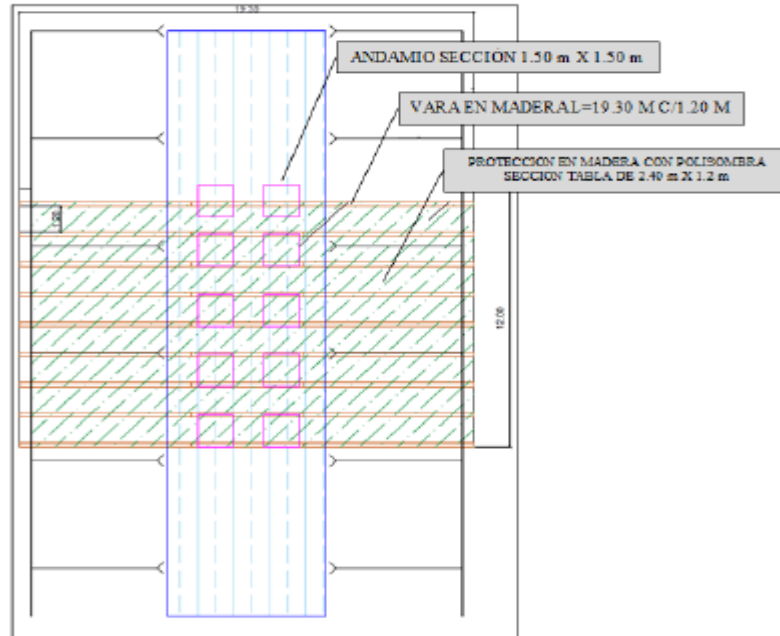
Diagrama planta de medidas de protección del canal Torca.
